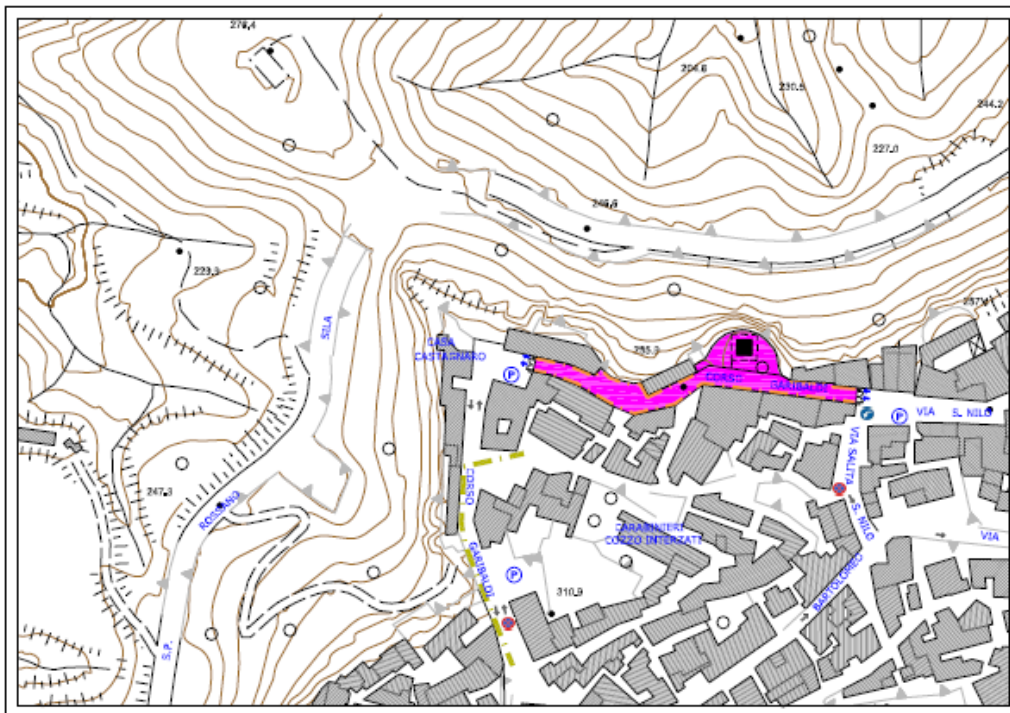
Stralcio della Tav. PSC3, raffigurante la seconda fase di lavoro
